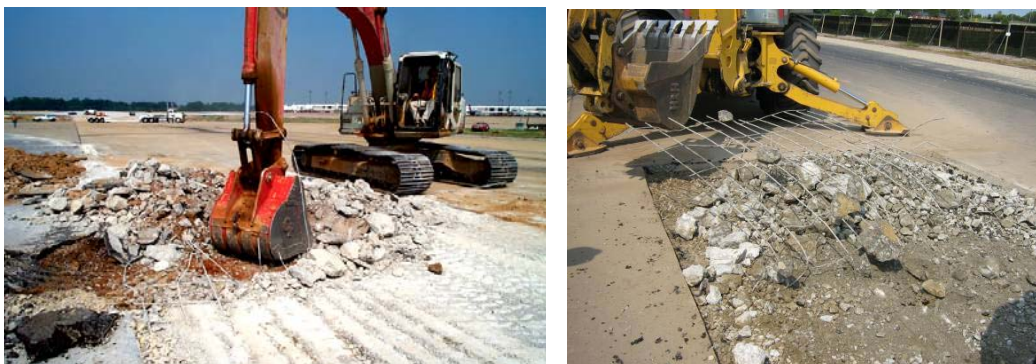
Pozos de sondeo para comprobación de la trituración del concreto y el desprendimiento del acero en la losa del pavimento (Asphalt Institute, 2008).
